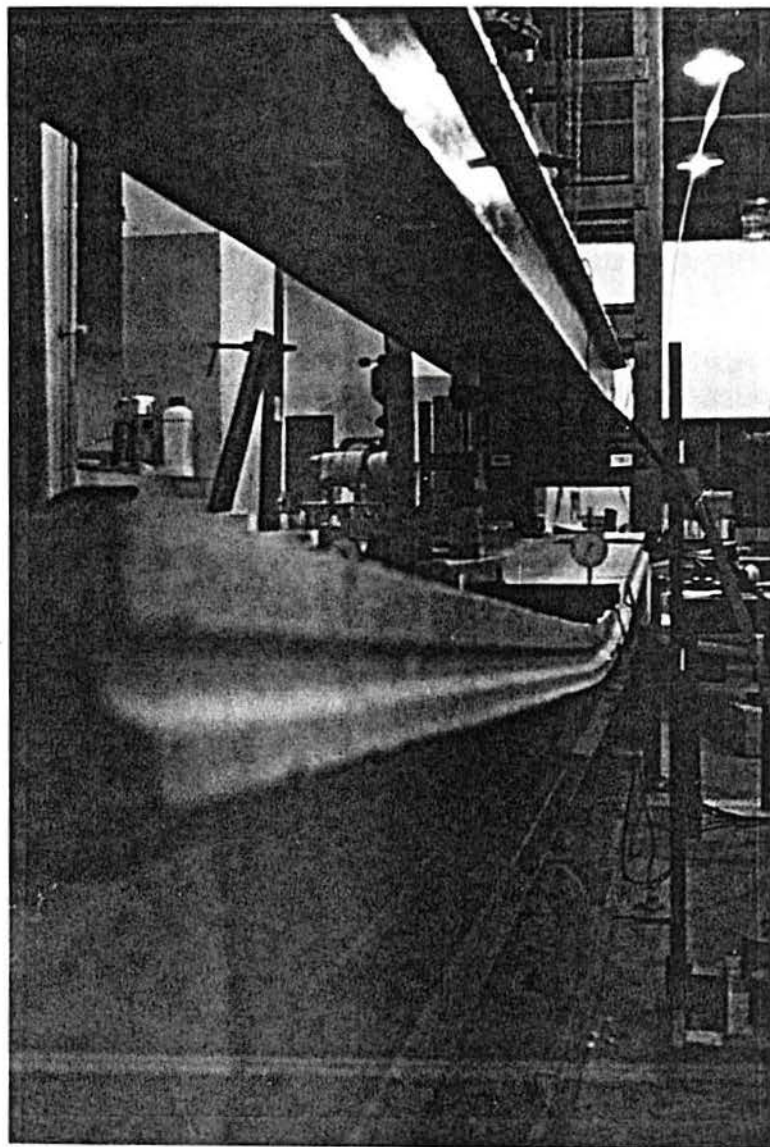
Vista do protótipo B1 durante o ensaio com carregamento concentrado
